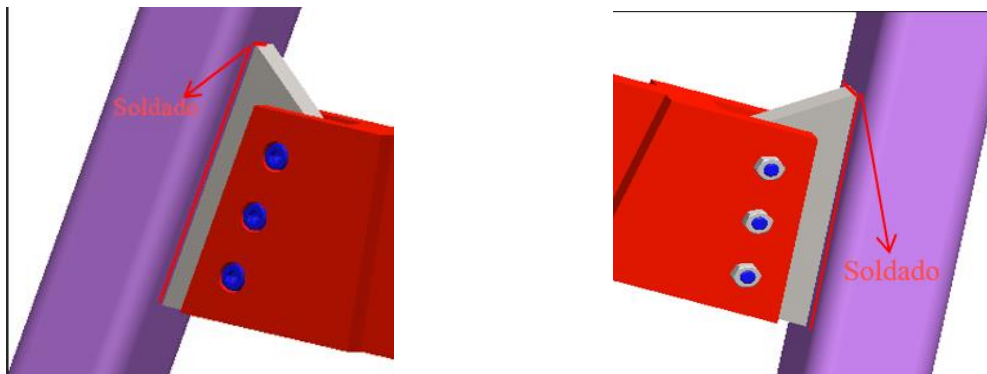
Vistas de soldado de cuñas de pieza N°1 (Fuente 85)
